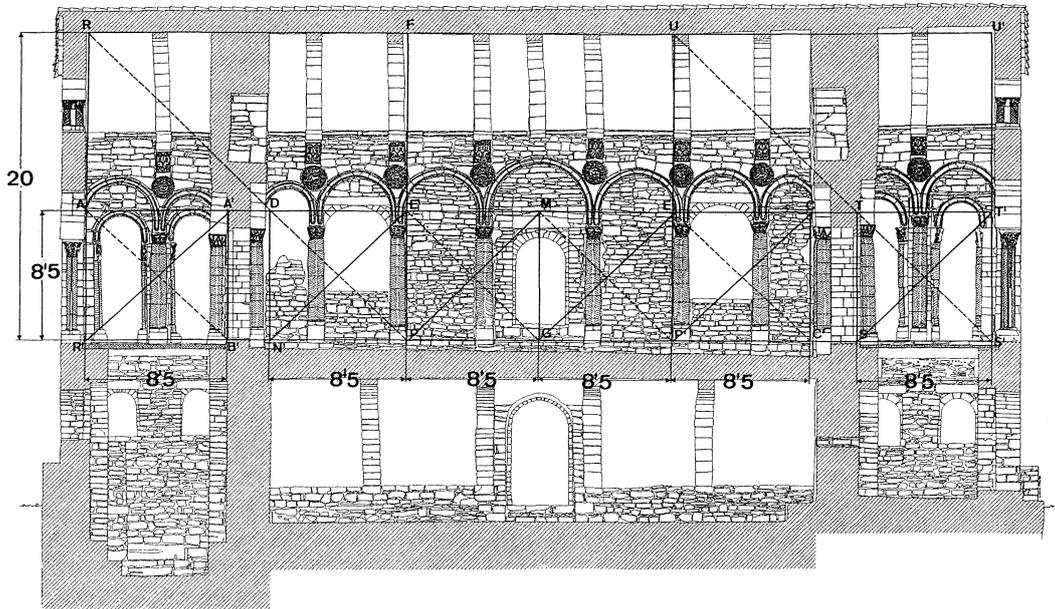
Santa María de Naranco. Sección longitudinal. Subdivisión en cuadrados de los intercolumnios de la arquería mural ciega de la sala superior.
